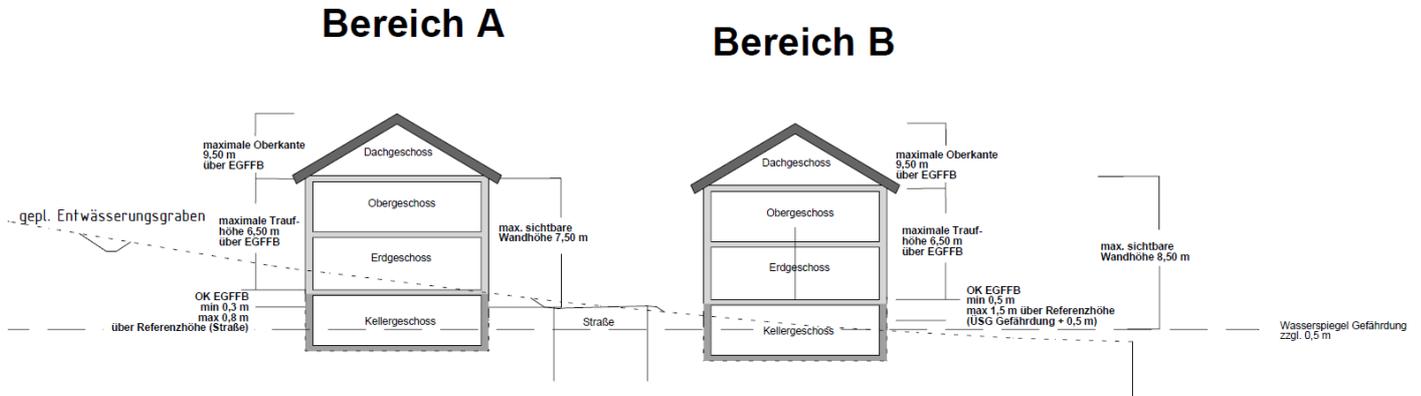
Schnittdarstellung Bereich A und B mit Gebäuden mit geneigtem Dach
